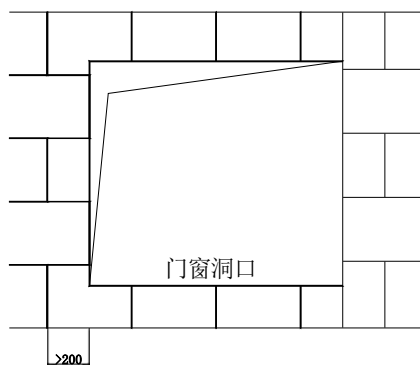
门窗洞口保温板排板示意 (单位: mm)
